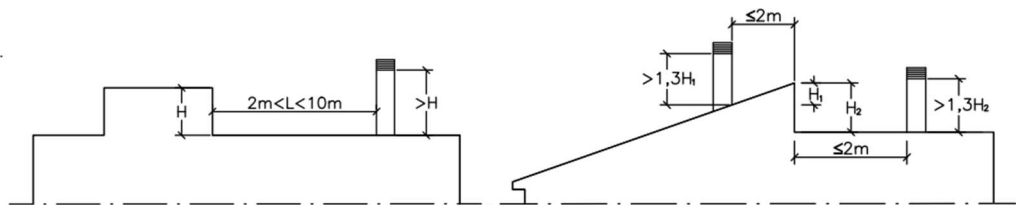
Ejemplos de altura libre del extremo superior de la bajante sobre la cubierta
